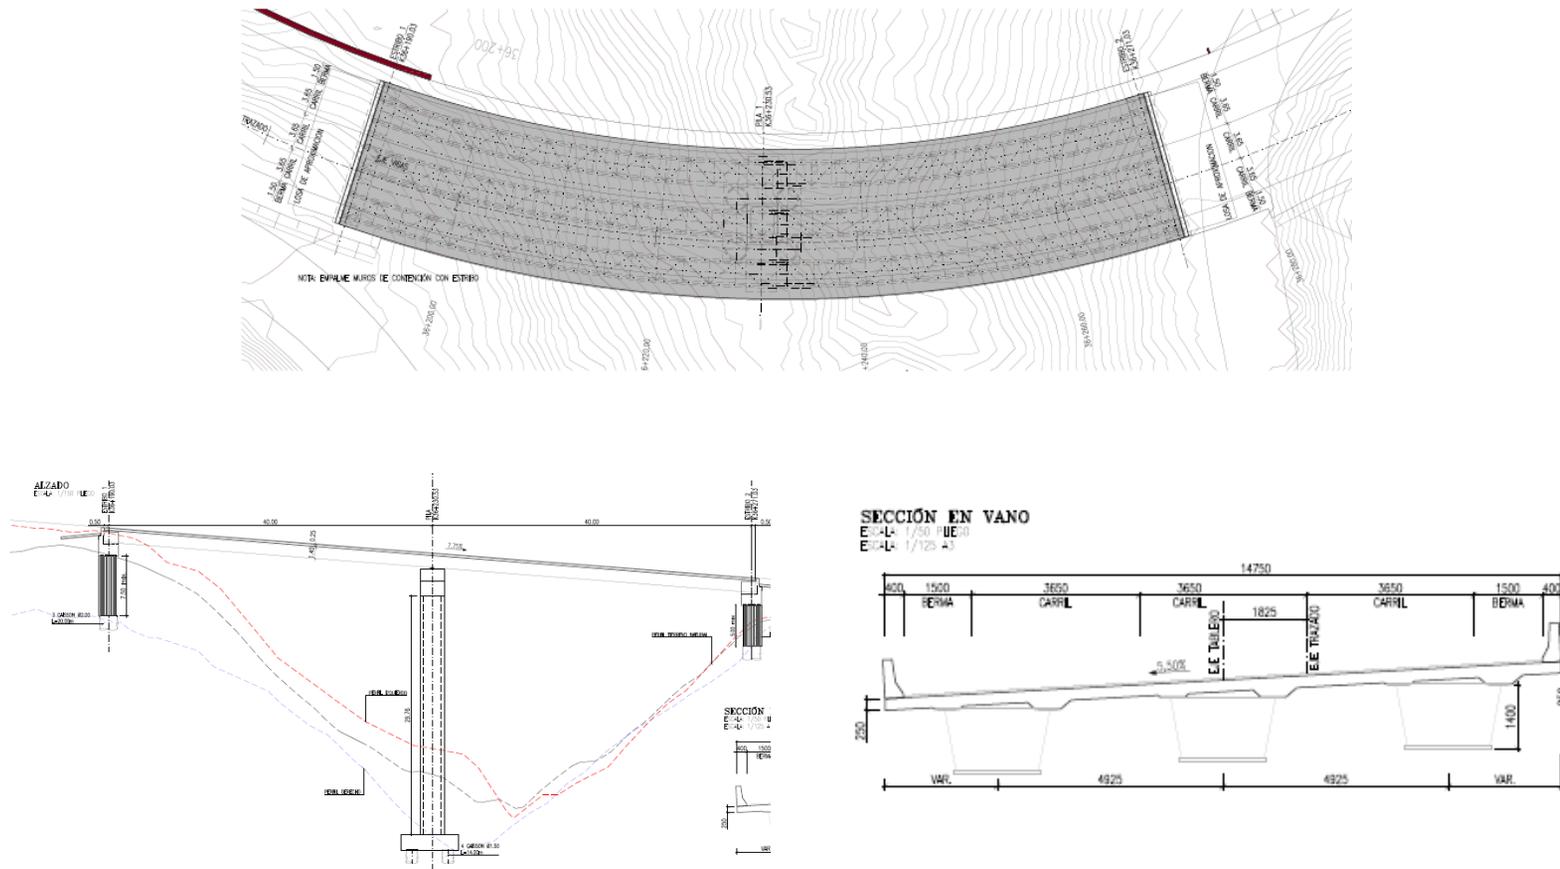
17. Planta y perfil del puente 49 de la carretera Cúcuta - Agua Clara (Hito 1). Fuente:(Instituto Nacional de Vías, 2011)
